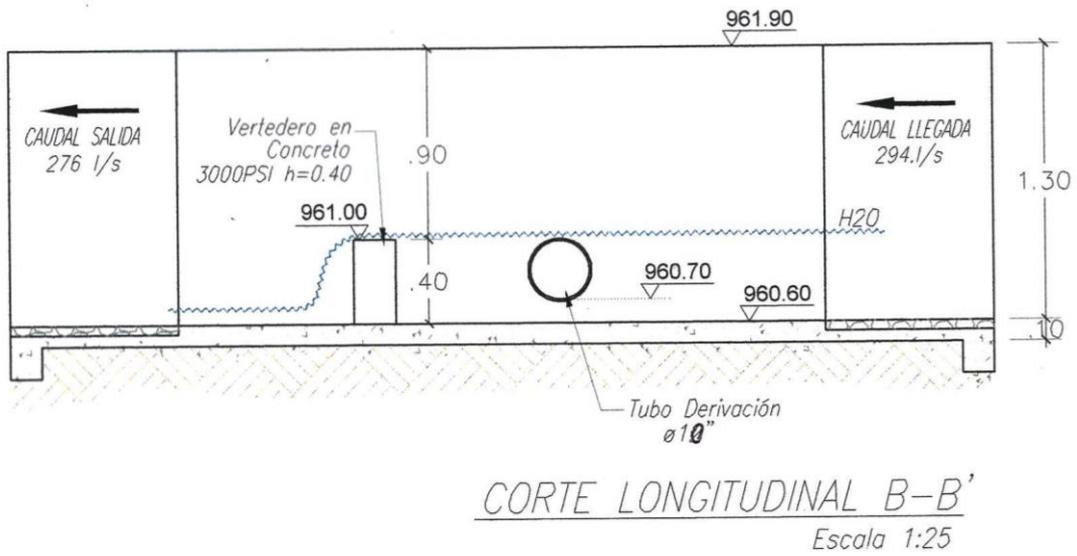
Detalles de la obra de captación, vista en corte longitudinal.
